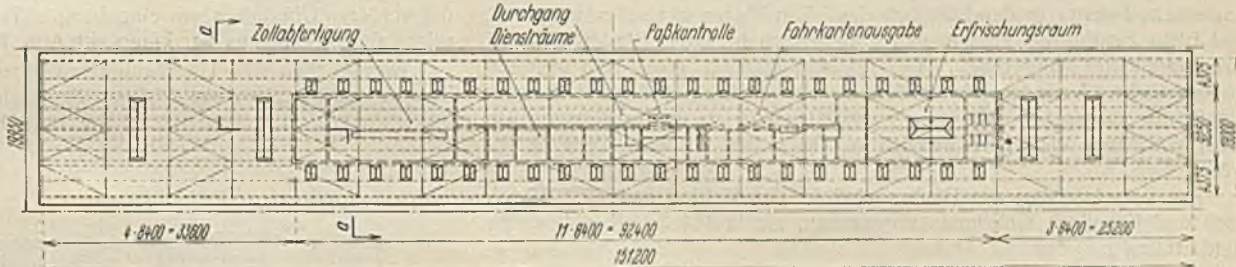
Grundriß der Zollhalle und Bahnsteigüberdachung.
